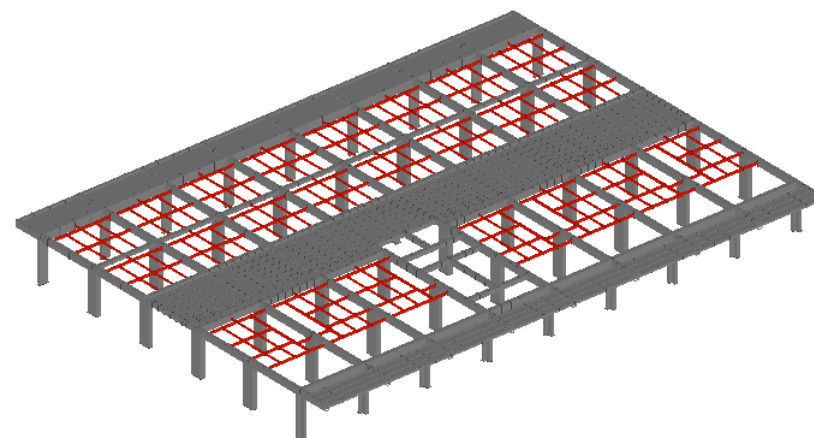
Detalle del modelo "sólido" de la estructura de la planta tipo vivienda.
